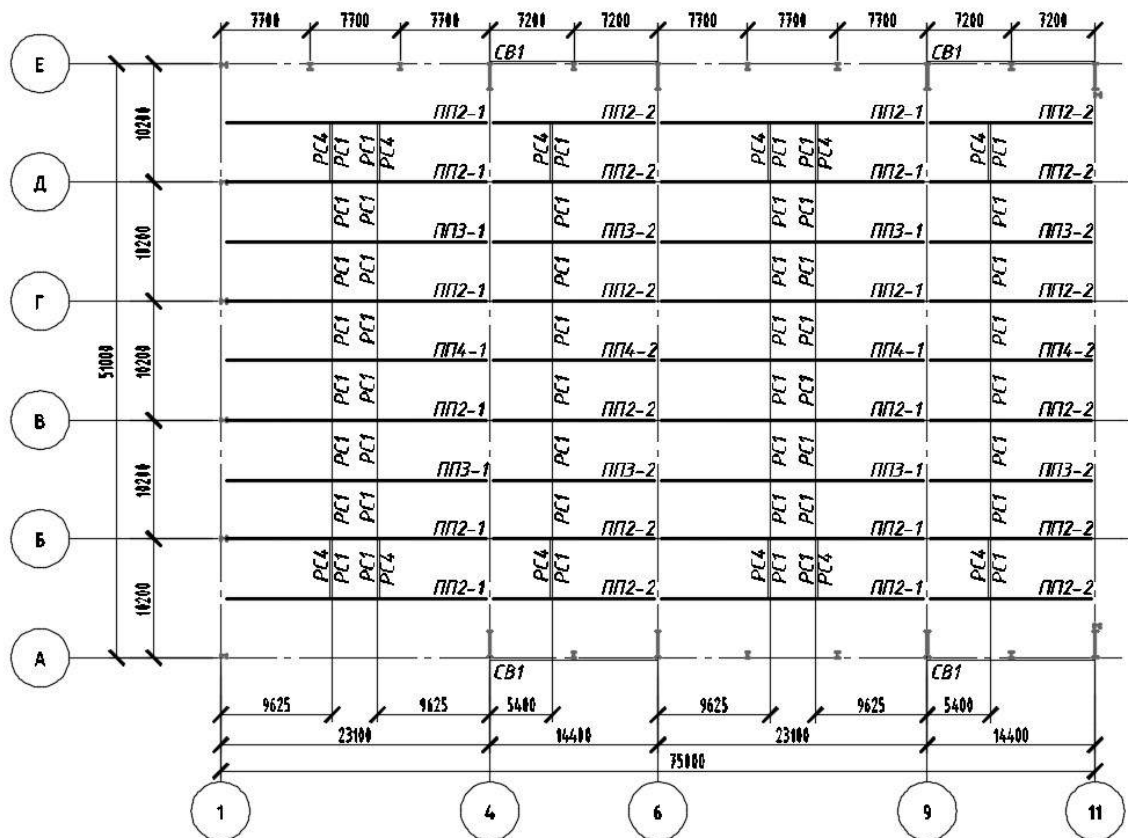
Схема конструкций по нижнему поясу балки покрытия
